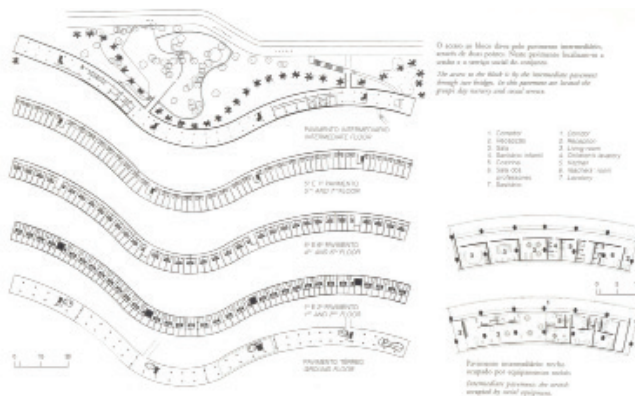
Plantas baixas e de situação e layout dos apartamentos do Pedregulho.
